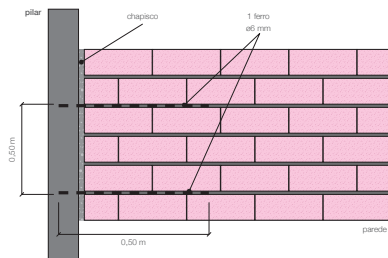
Ligação da alvenaria a uma estrutura de betão
